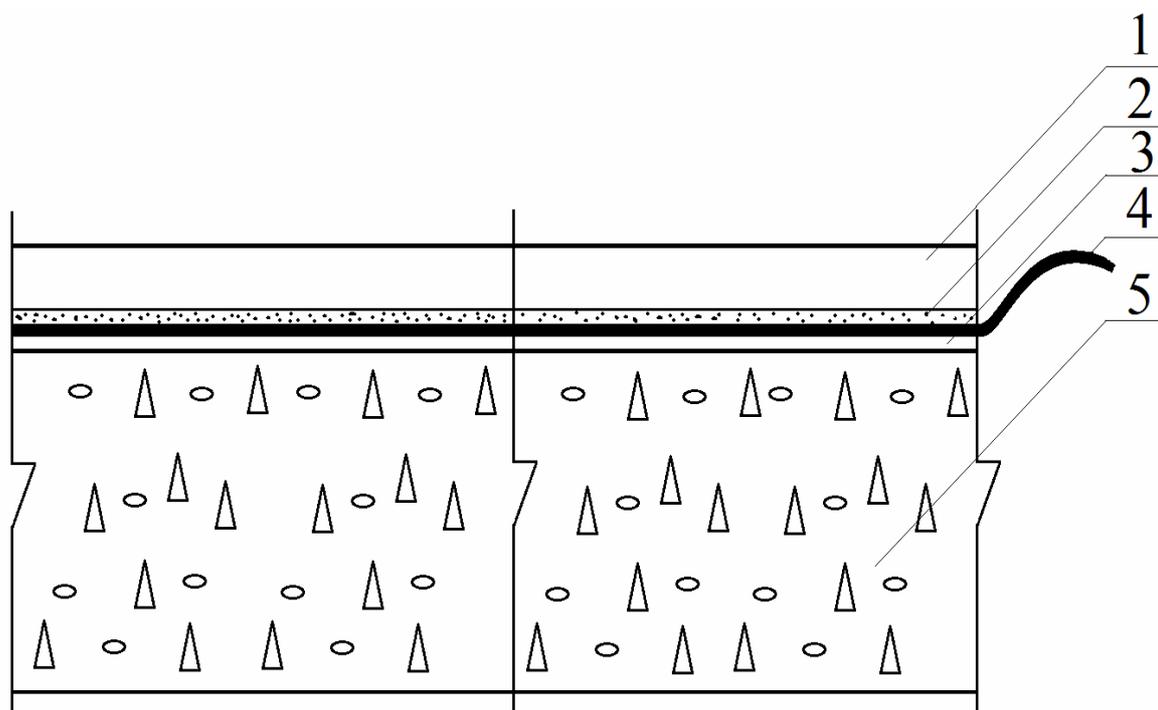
Полимерные антистатические покрытия для бетонной плиты на грунте
